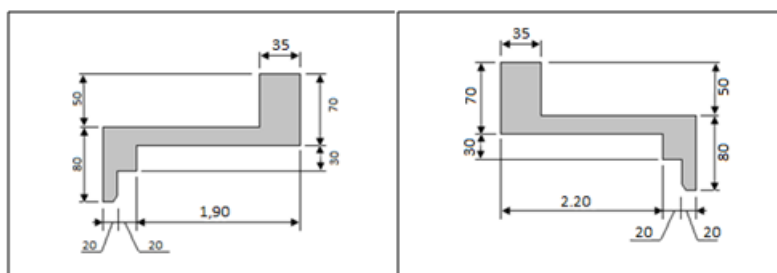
Coupe transversale du trottoir avec la corniche.
